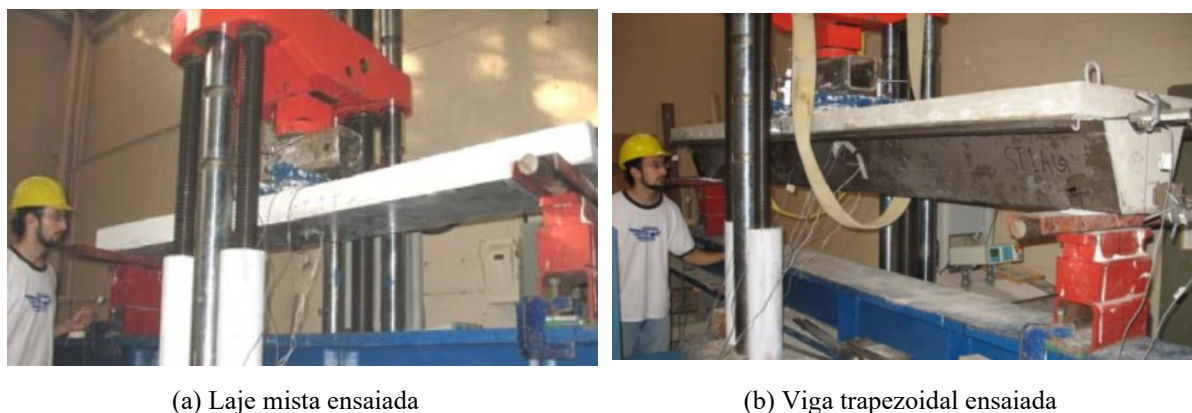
Lajes e vigas compósitas (Honickman, 2008). (a) Laje compósita ensaiada; (b) Viga trapezoidal ensaiada.
